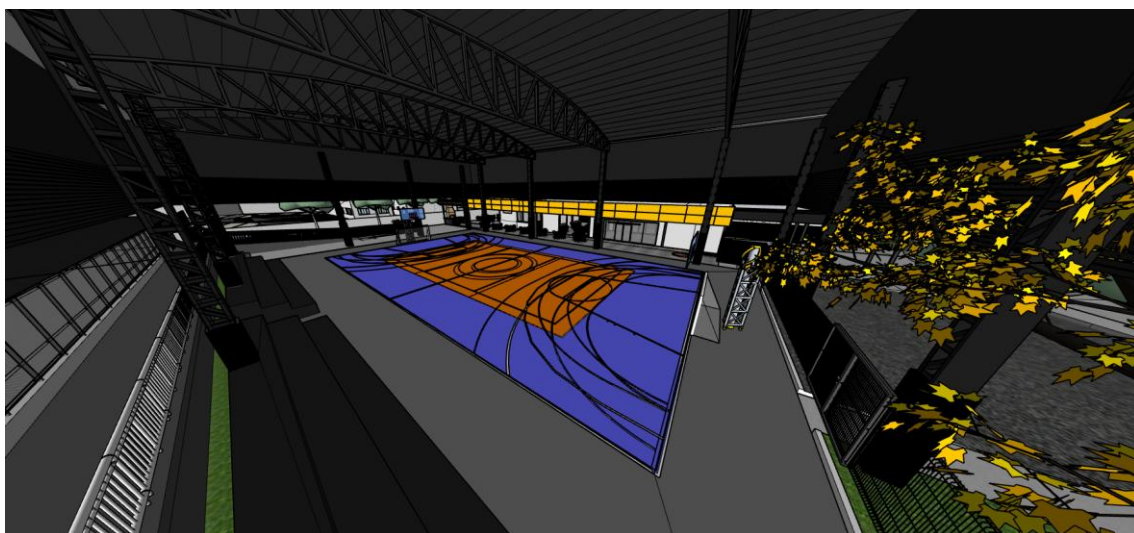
Pintura das estruturas metálicas existentes (pilares/terças/telhas) e pintura do piso.
